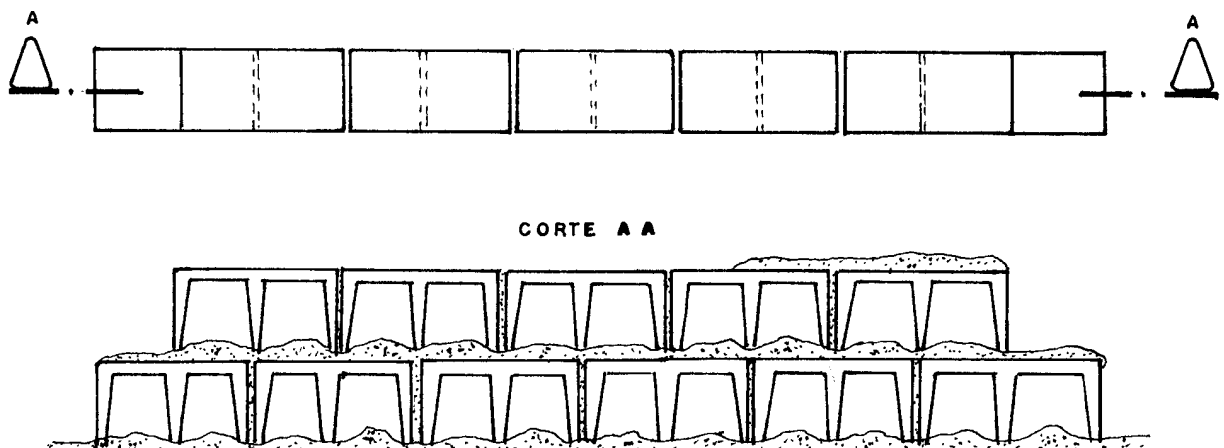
Detalhe do assentamento do bloco de concreto
